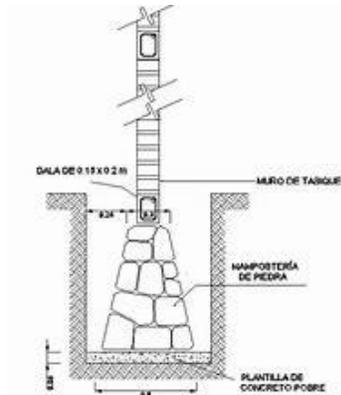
Estructura de la cimentación de Casa Expo Temporal.
